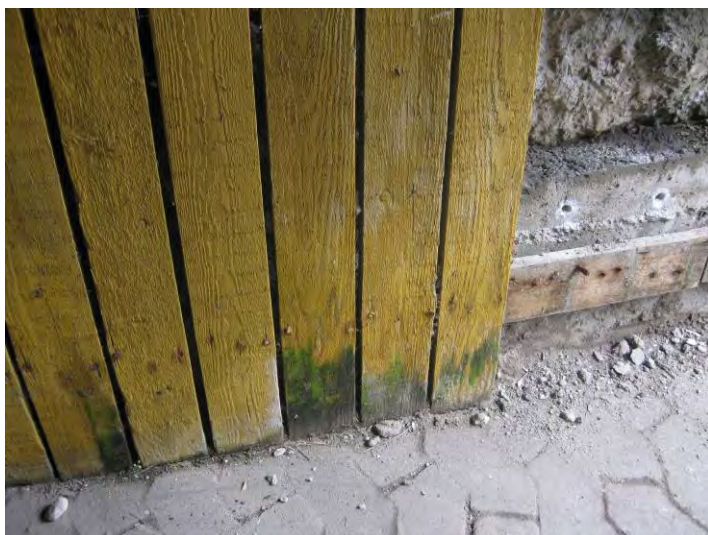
Kraftig opfugtning i træplanker (NØ)
